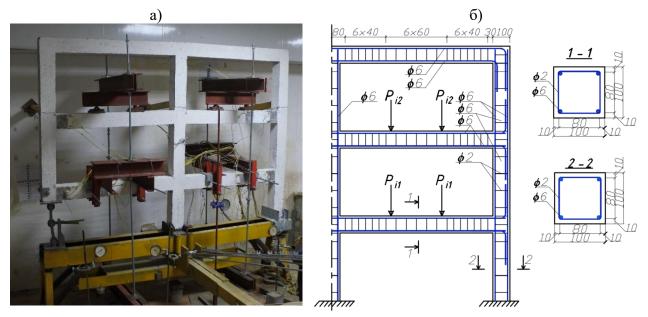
Общий вид испытаний (а) и схема армирования (б) железобетонной рамы
